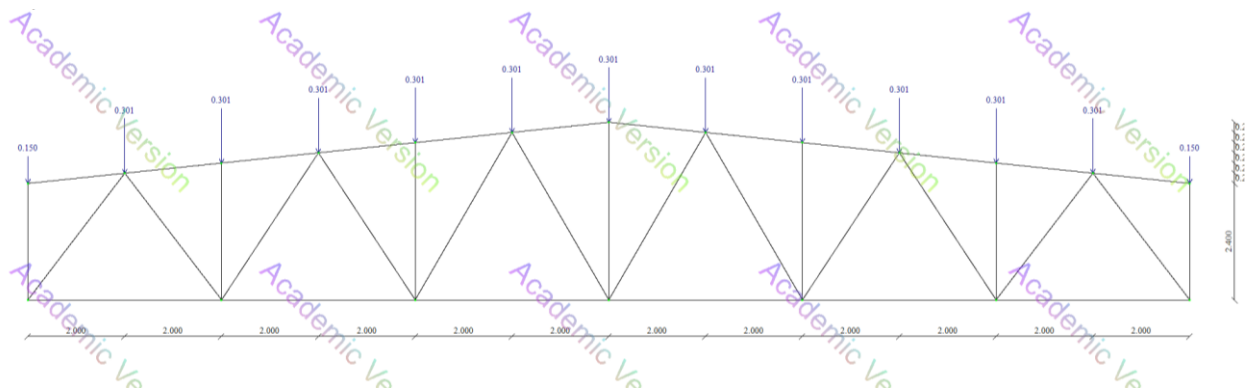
Розрахункова схема ферми за першим навантаженням (вага покриття)
